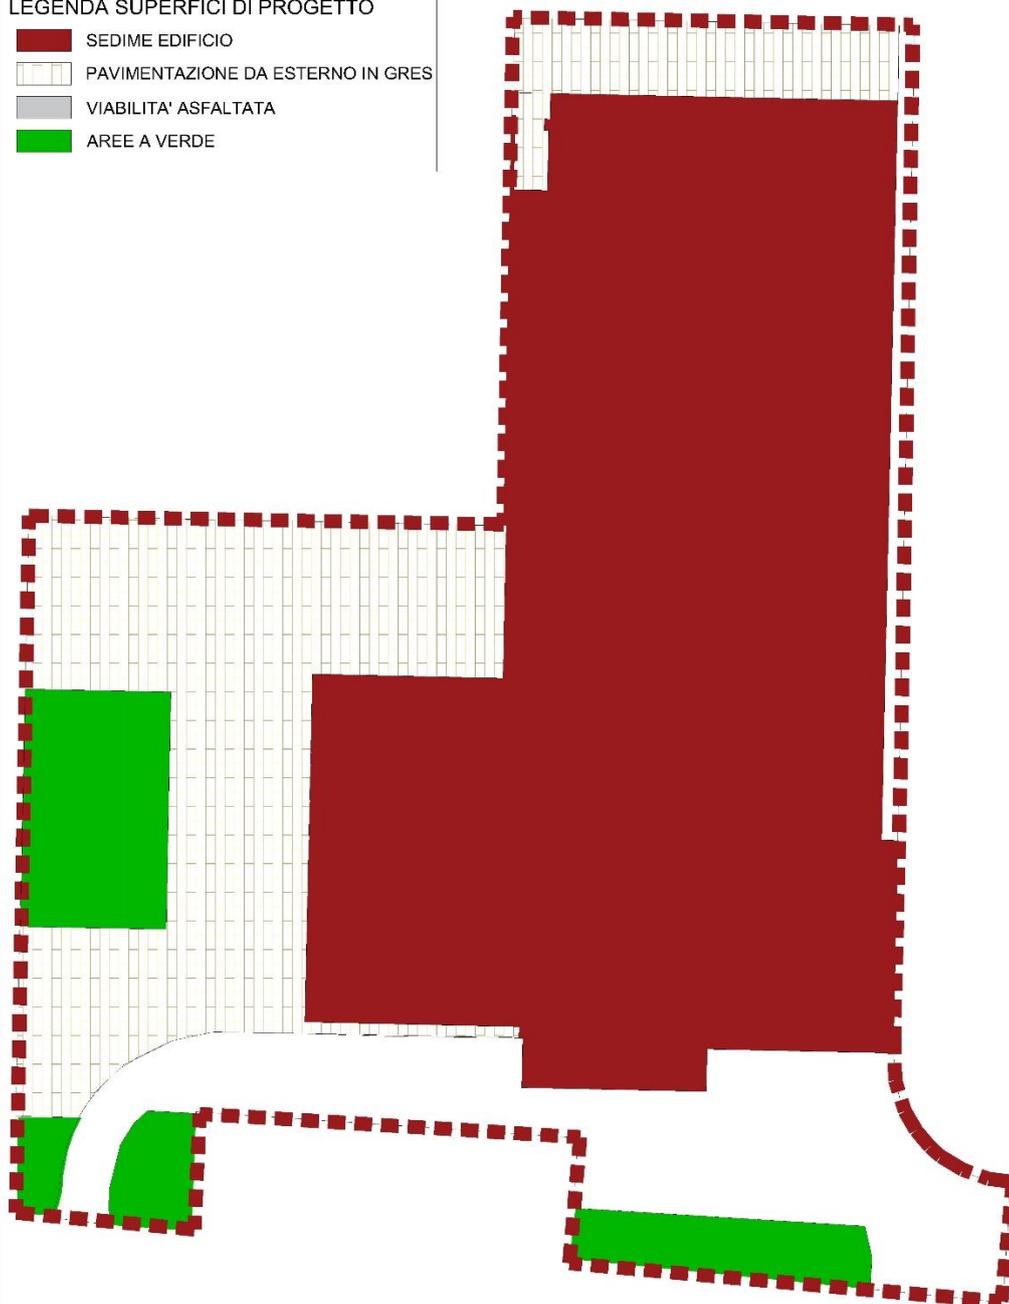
Suddivisione schematica delle superfici scolanti nell'assetto di progetto
